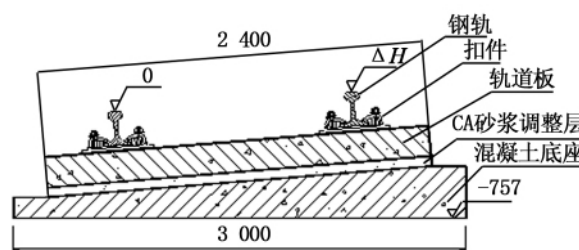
曲线路基地段 I 型板式轨道断面图(单位: mm)
